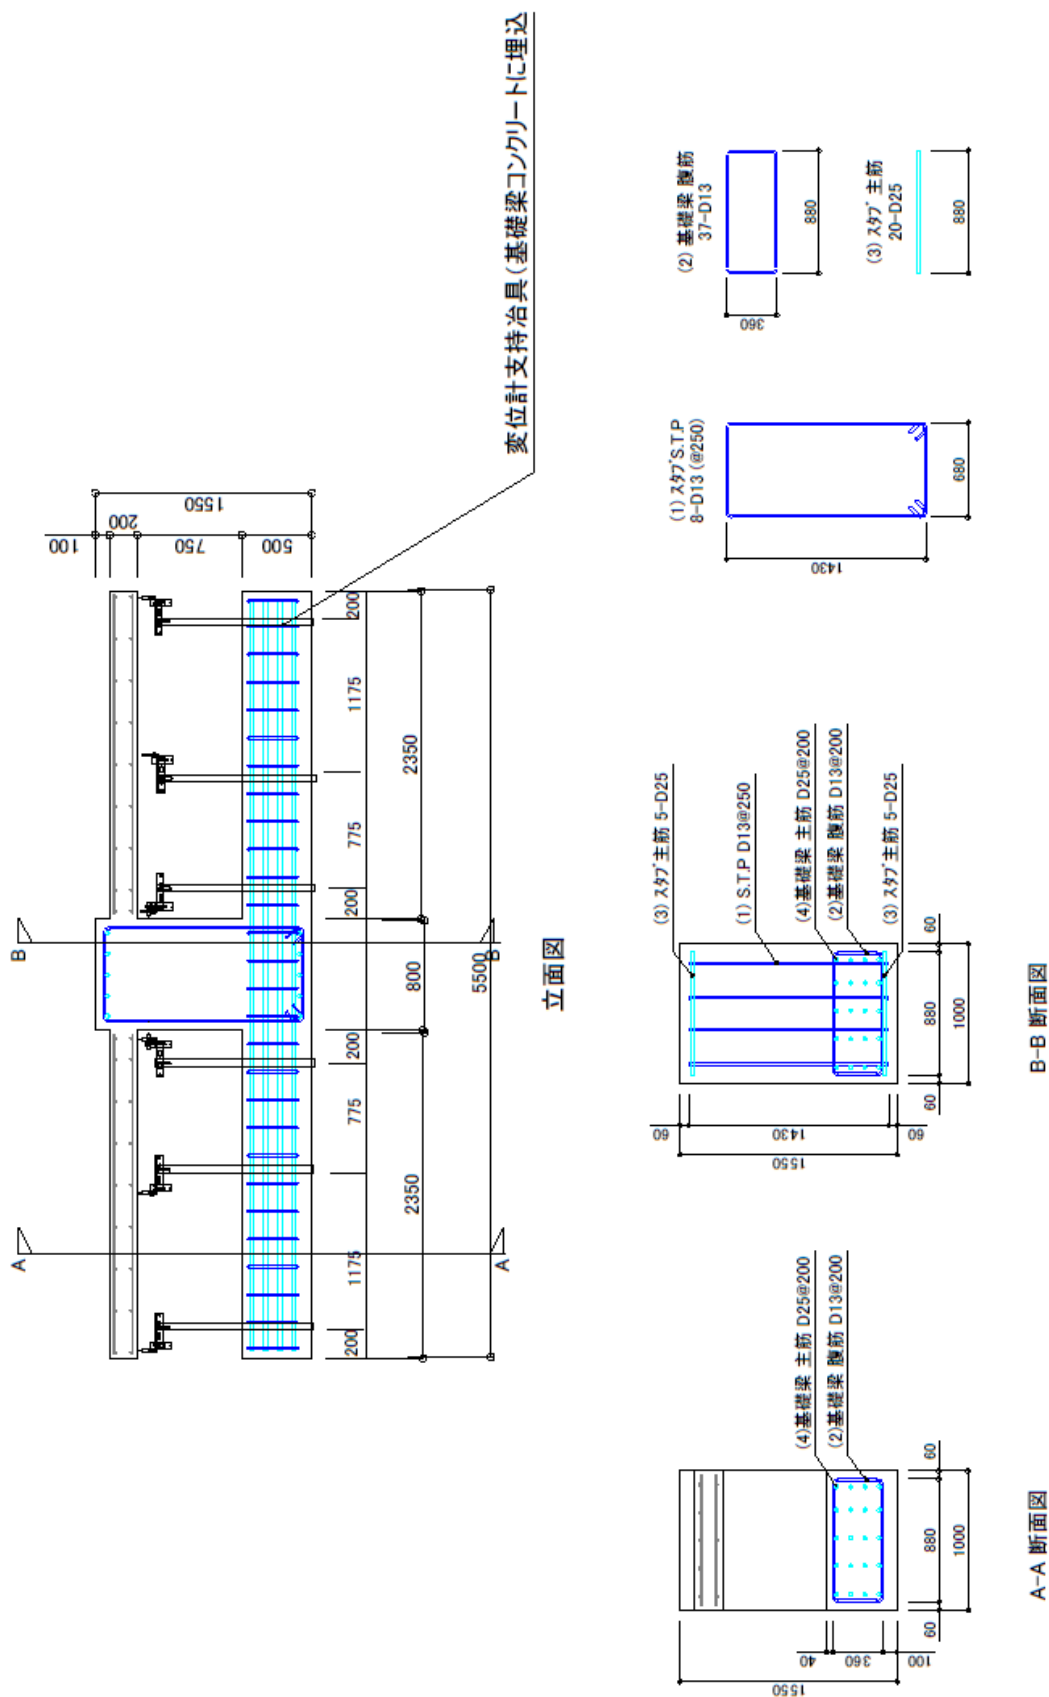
基礎梁および梁の配筋図(CA, CB 試験体)
